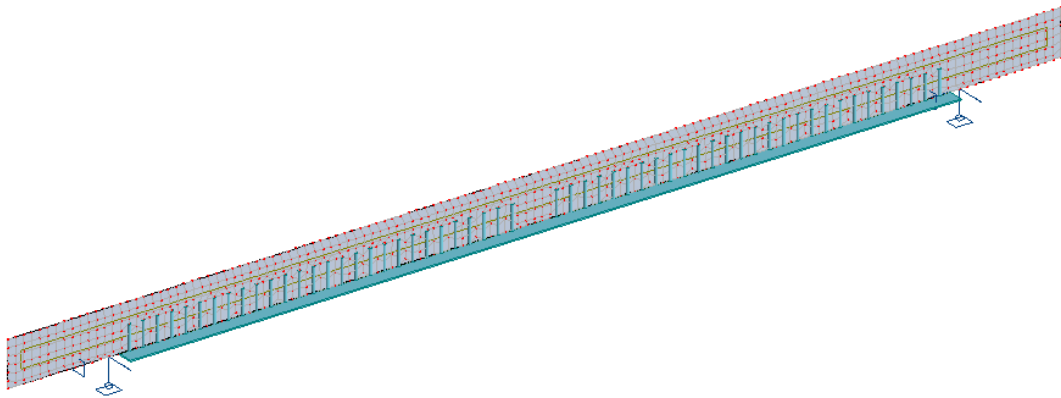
Discretização da viga reforçada por meio de chapa de aço.
